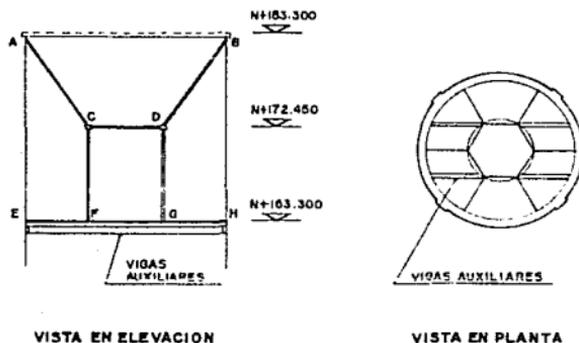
Estructuración para losas en niveles N+163.300 y N+172.450
